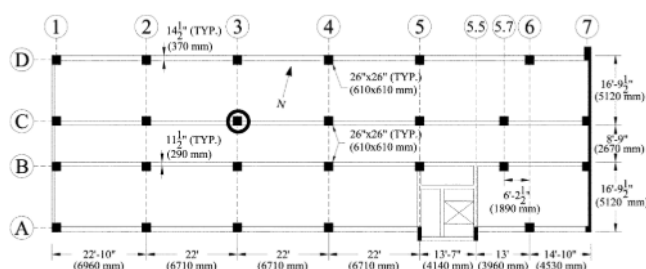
Planta baixa do primeiro pavimento (Sasani et al., 2010)
